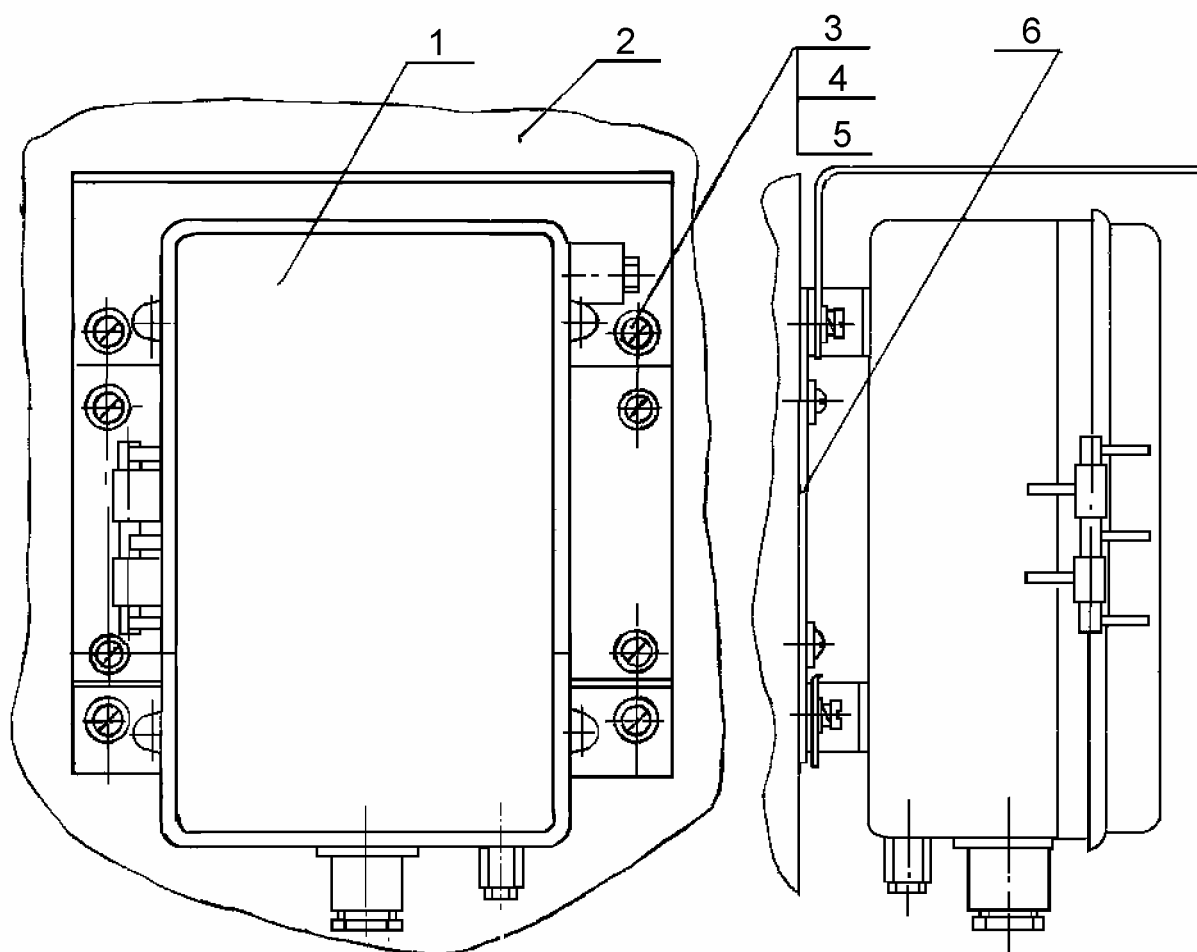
Установка БЗ (БОС) на ЗГР, стенах зданий
